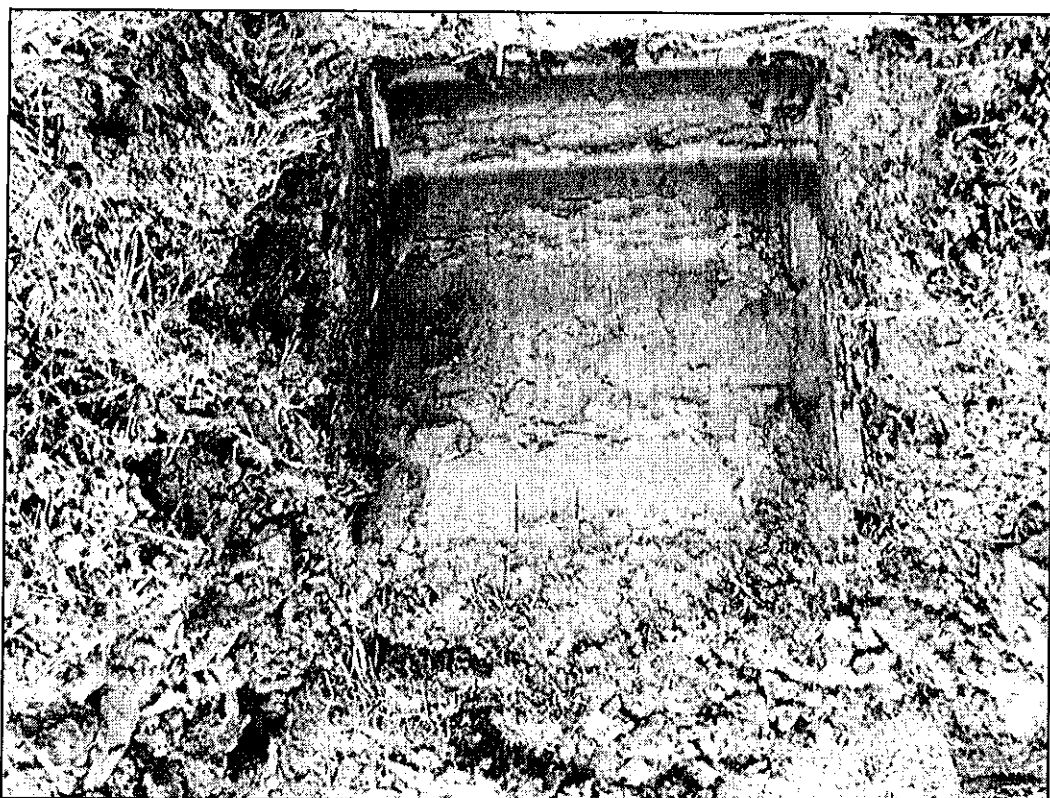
Pozzetto n° 18. Profondità -1.8 m dal p.c.
